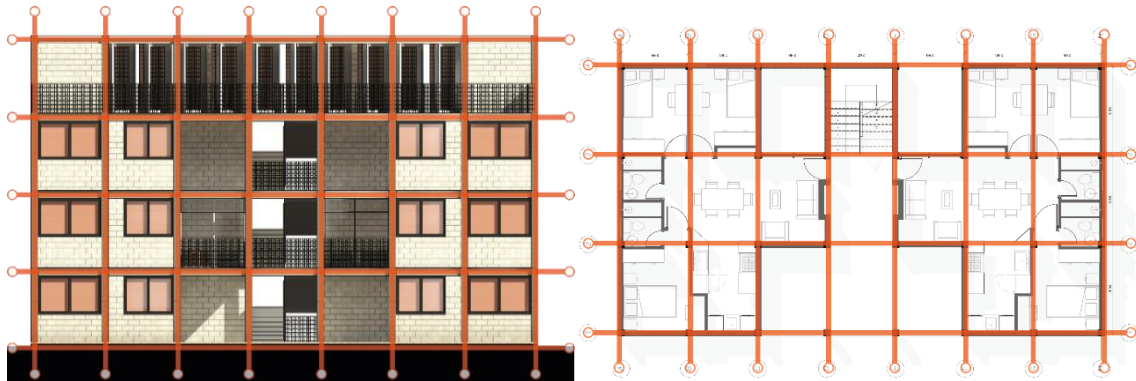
Modulación en fachadas (izquierda) y plantas (derecha) de los Departamentos San Telmo
